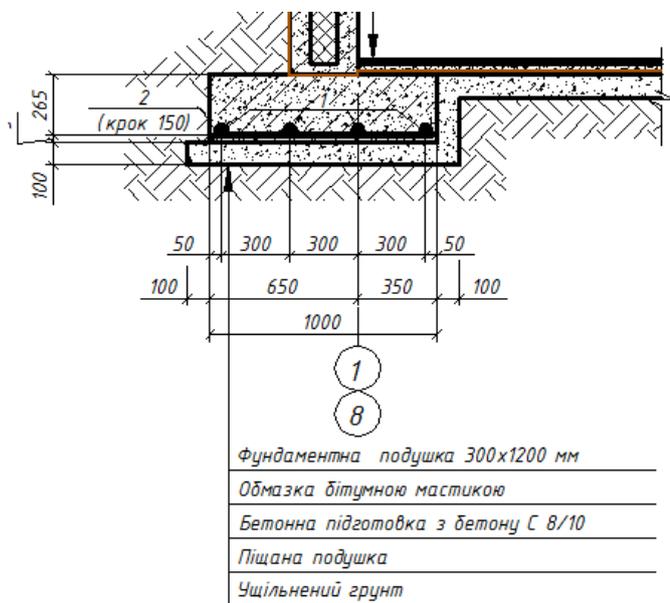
Залізобетонні монолітні стрічкові фундаменти
